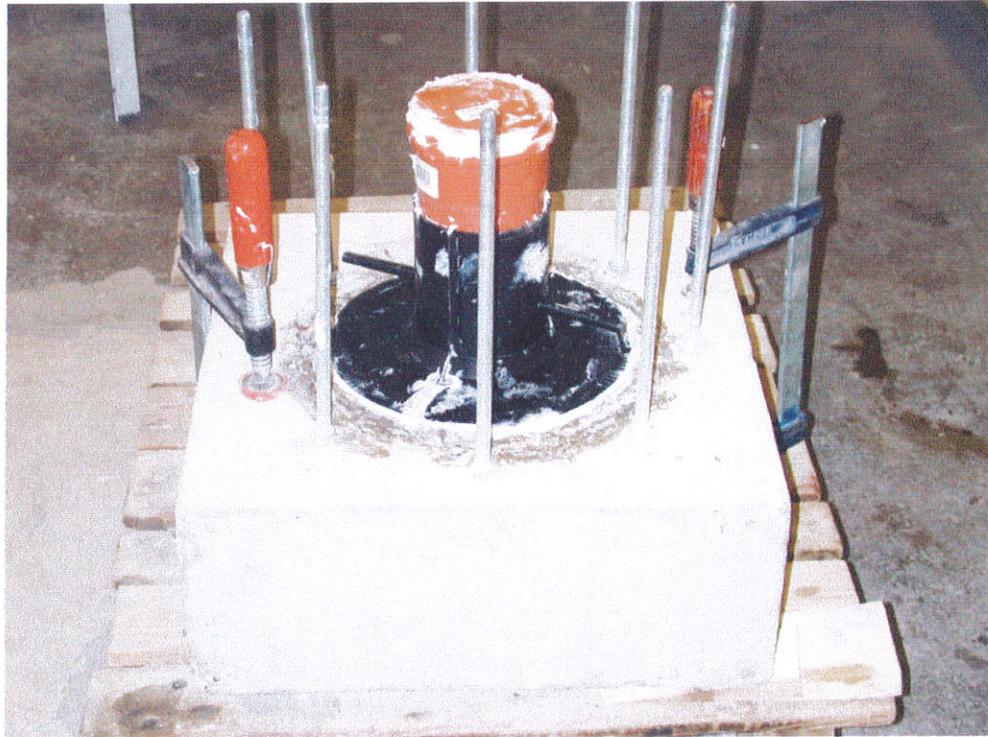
Probekörper für den Dichtigkeitstest mit eingebauter Spaltabdichtung „Remmers Rohrflansch“
